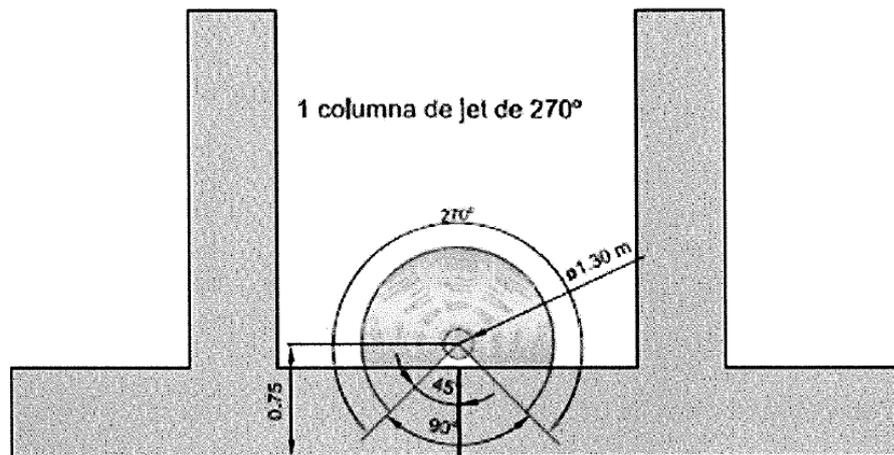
Vista en planta de la impermeabilización de una junta de pantalla de hormigón con una columna de jet sectorial
